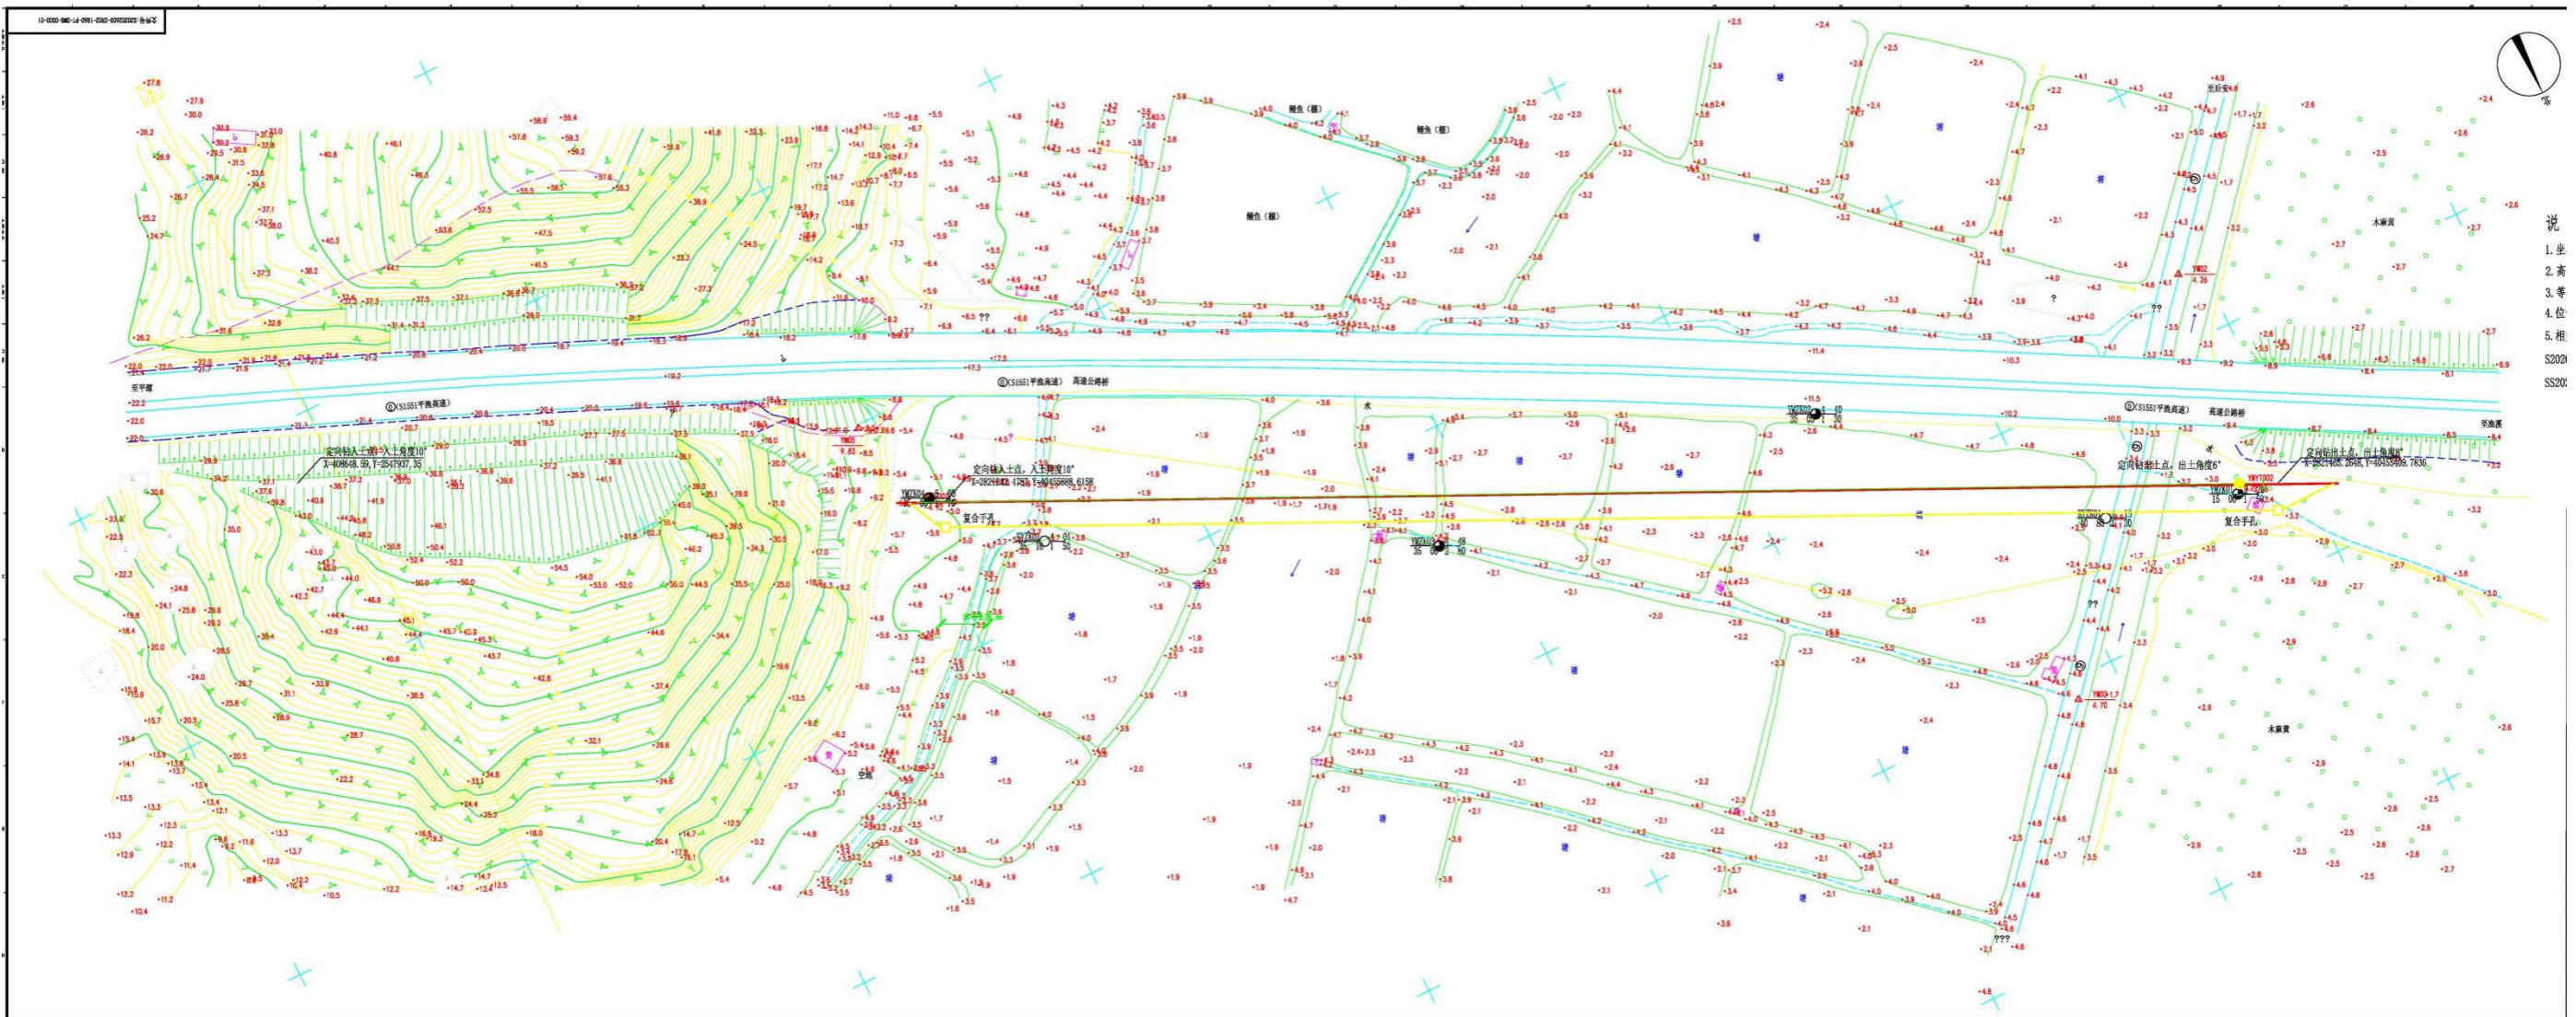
洋门村连片鱼塘穿越平面示意图
